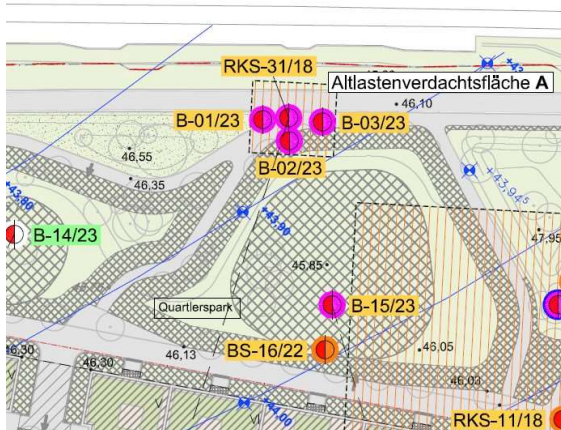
Ausschnitt Altlastenverdachtsfläche A, Bodenbelastungen im Bereich geplanter Versickerungsanlagen [A10]
